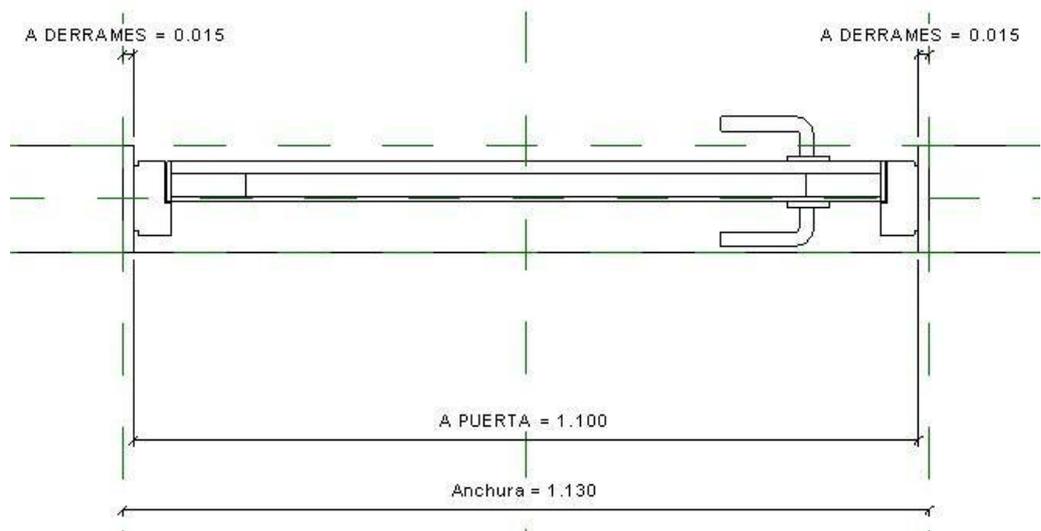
Identificación de cotas asignadas en vista en planta a parámetros de familias de Autodesk Revit
